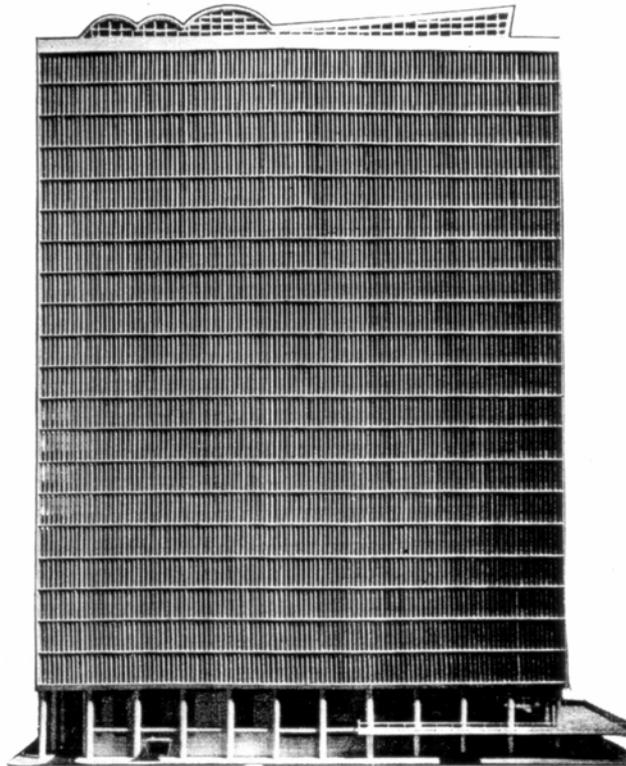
Fachada por Reidy: elevação envidraçada com elementos verticais móveis, as lajes em balanço demarcam os vinte pavimentos apoiados sobre a superestrutura aparente. O terraço abriga o bar-restaurant.
